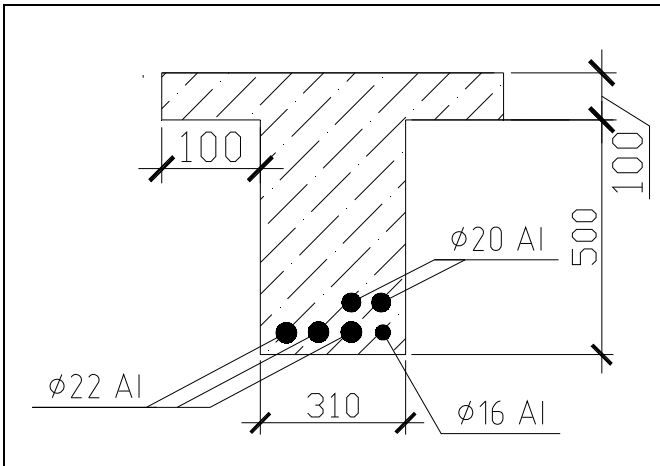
Балка ж/б перекрытия над третьим этажом в осях «8–11/А–Б, В–Г»
